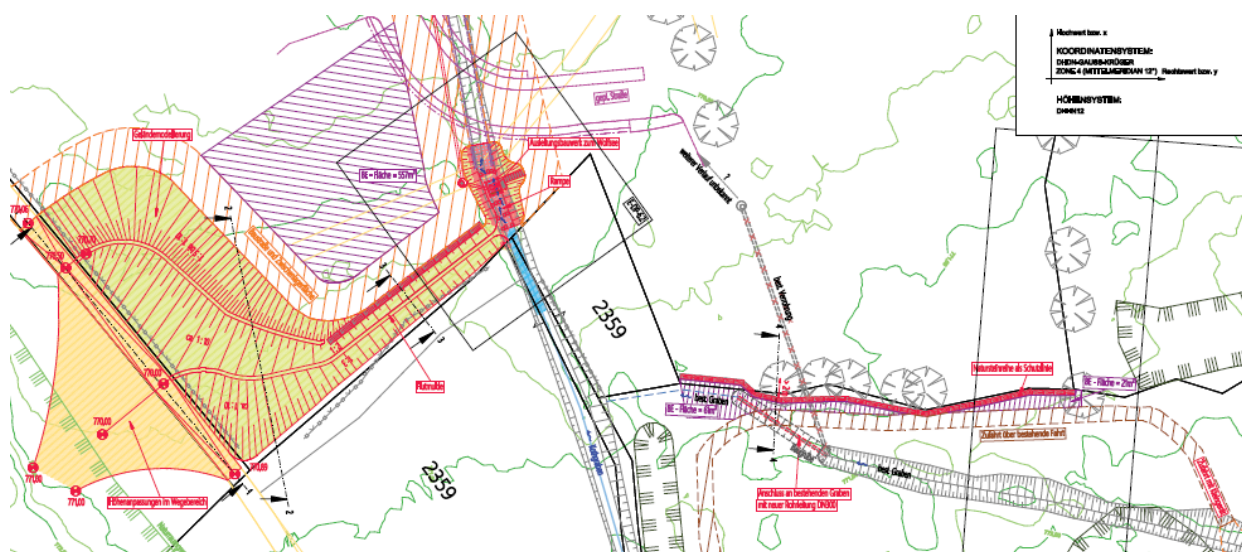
Planauszug – Planungsabschnitt Geländemodellierung.
